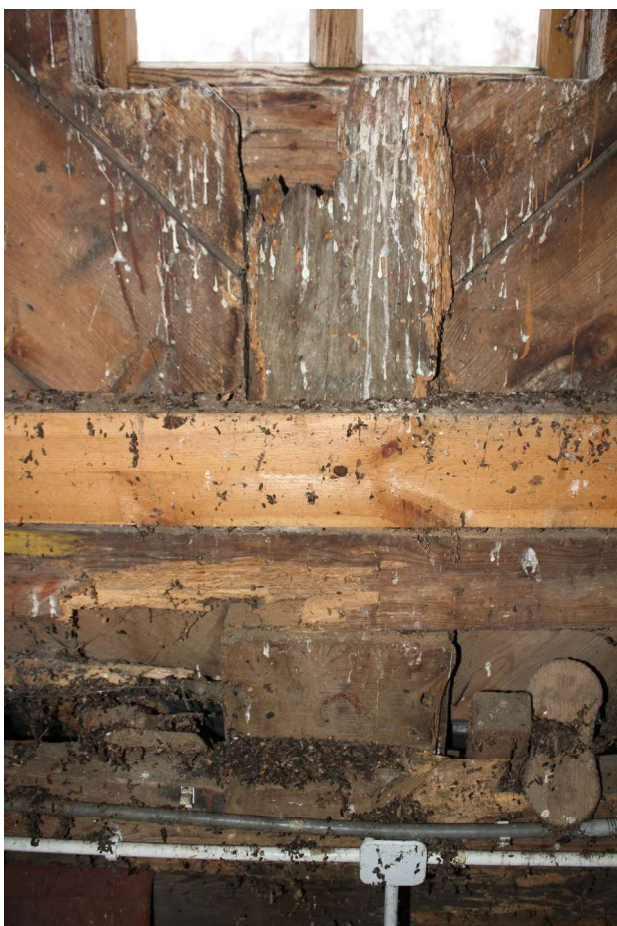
Więźba dachowa, widok w kierunku północno-wschodnim.
